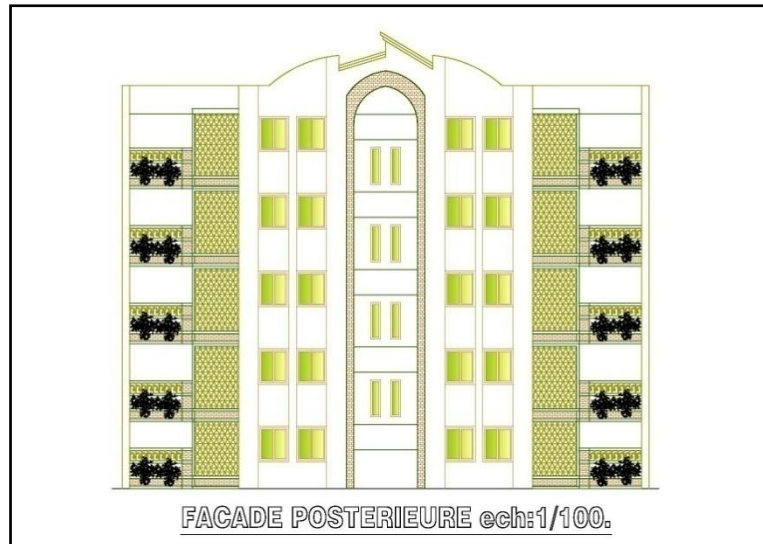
Façade postérieure d'un logement collectif à Jijel.
